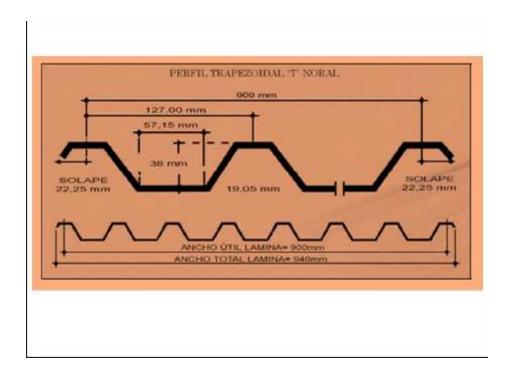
Dimensiones de la cobertura trapezoidal de aluminio
